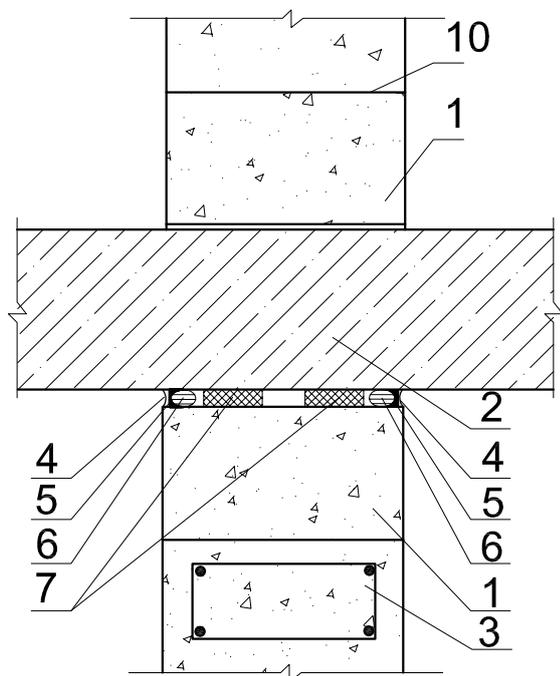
Схемы узлов опирания железобетонного перекрытия на перемычки
